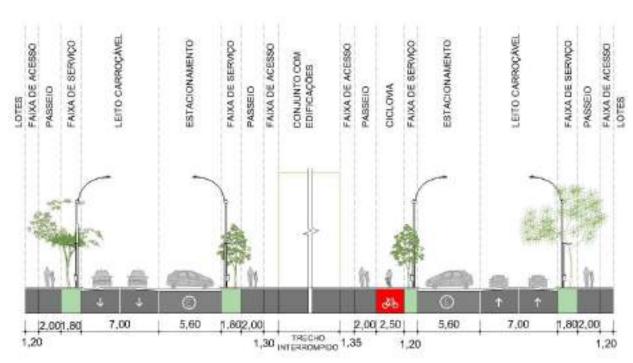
Corte Esquemático 04 – Vias de Circulação na EQNM 38 conjunto B.
